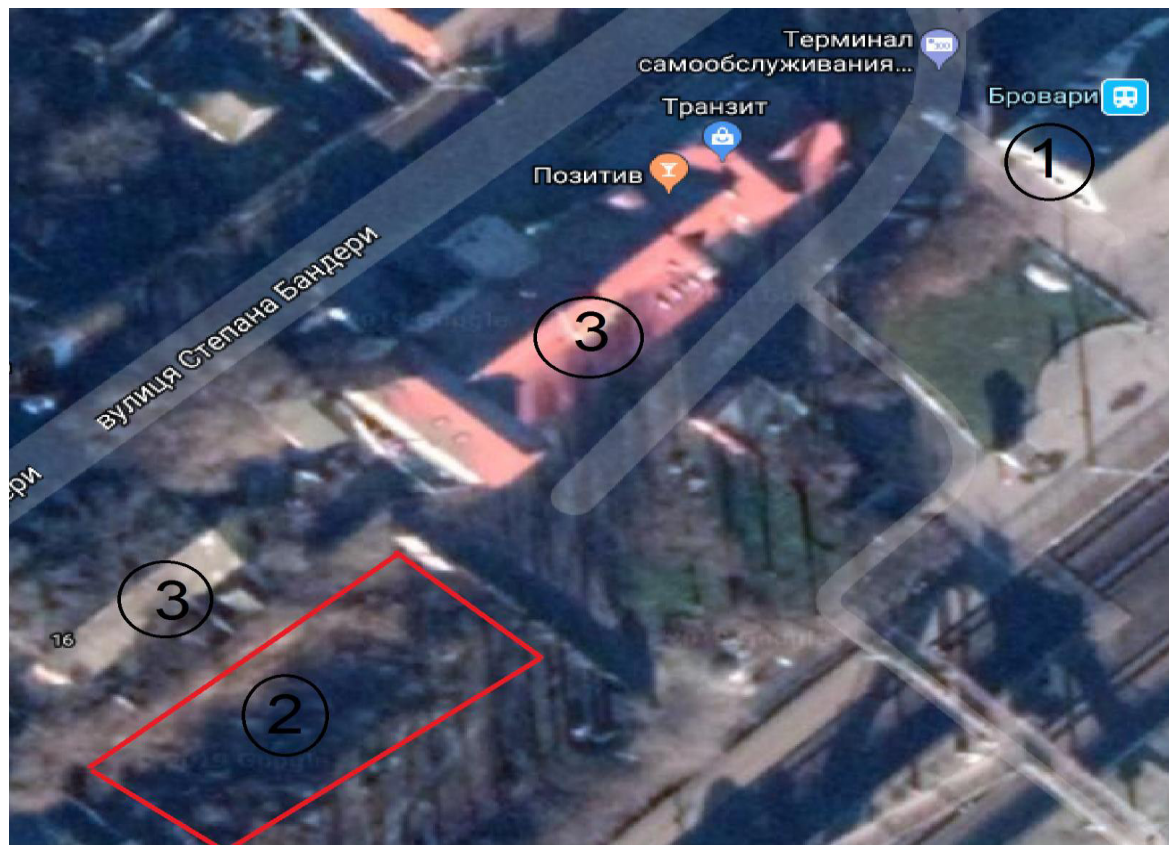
Схематичний план розміщення будівельного майданчику ТЦ відносно залізничного вокзалу «Бровари» та колій залізниці: 1 – будівля вокзалу «Бровари»; 2 – будівельний майданчик ТЦ; 3 – існуючі будівлі
